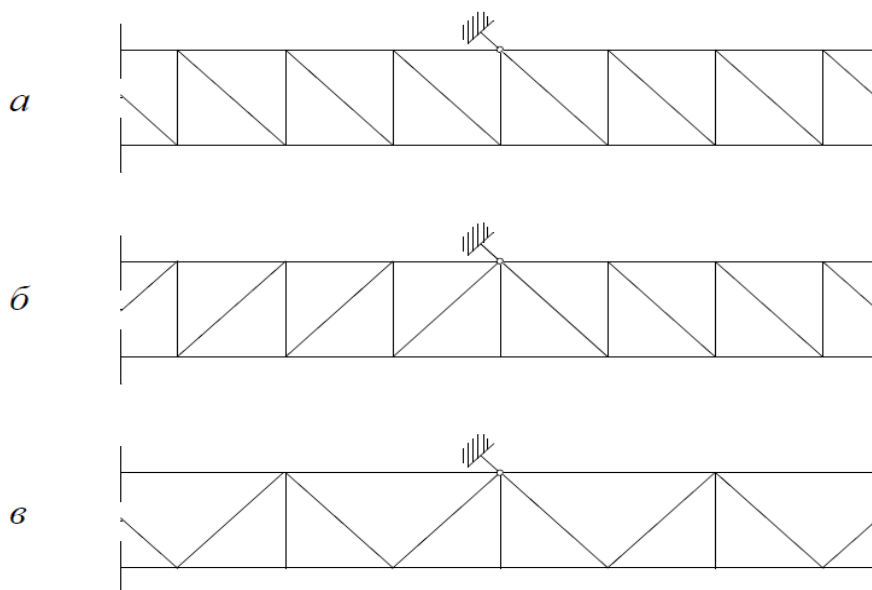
Типы соединительных решеток вертикальных ферм балочных стрел:
